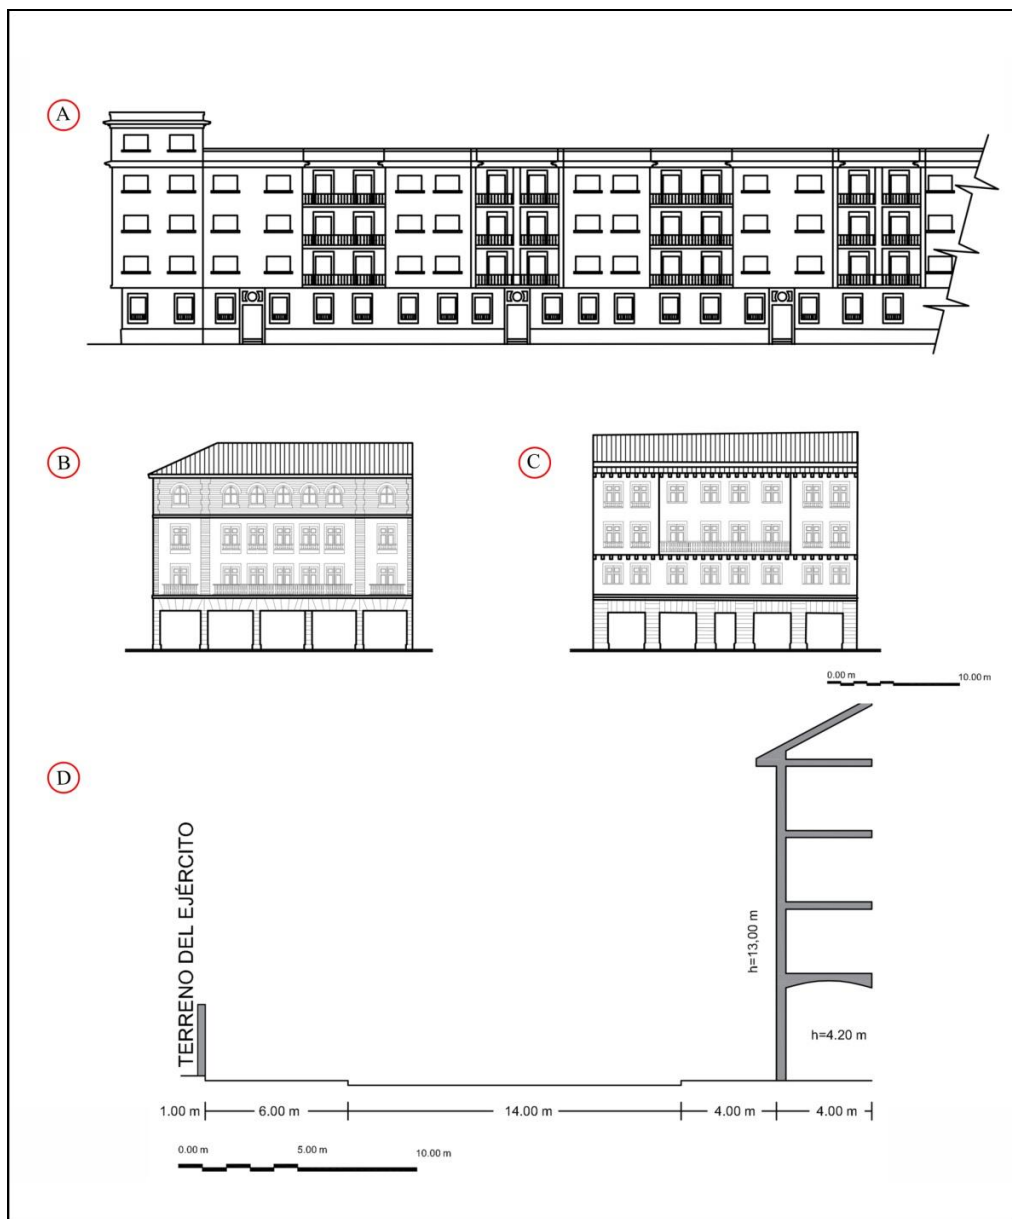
Alzados tipo y trazado de la Pista Militar: a) alzado para la Pista Militar en el tramo de la Dehesa; b) alzado de la Pista Militar zona Alto de los Leones; c) alzado tipo para la zona de transición al ensanche, y d) sección de la Pista Militar. (Fuente: Elaboración propia).
